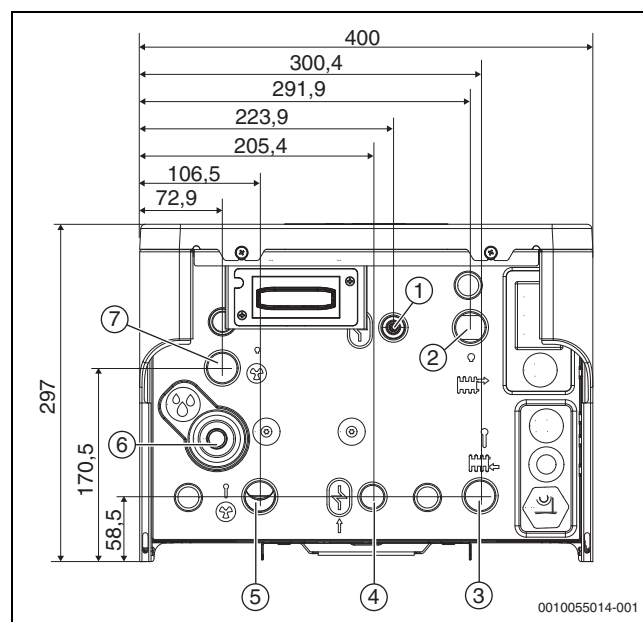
Abmessungen und Anschlüsse auf der Unterseite (Maße in mm)
